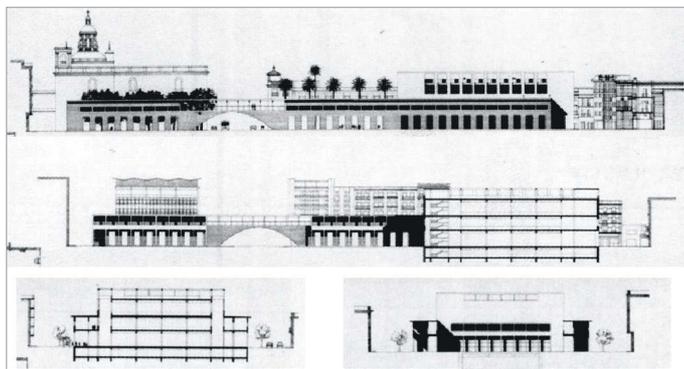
Alzados de la propuesta de Plan Especial de Guillermo Vázquez Consuegra
